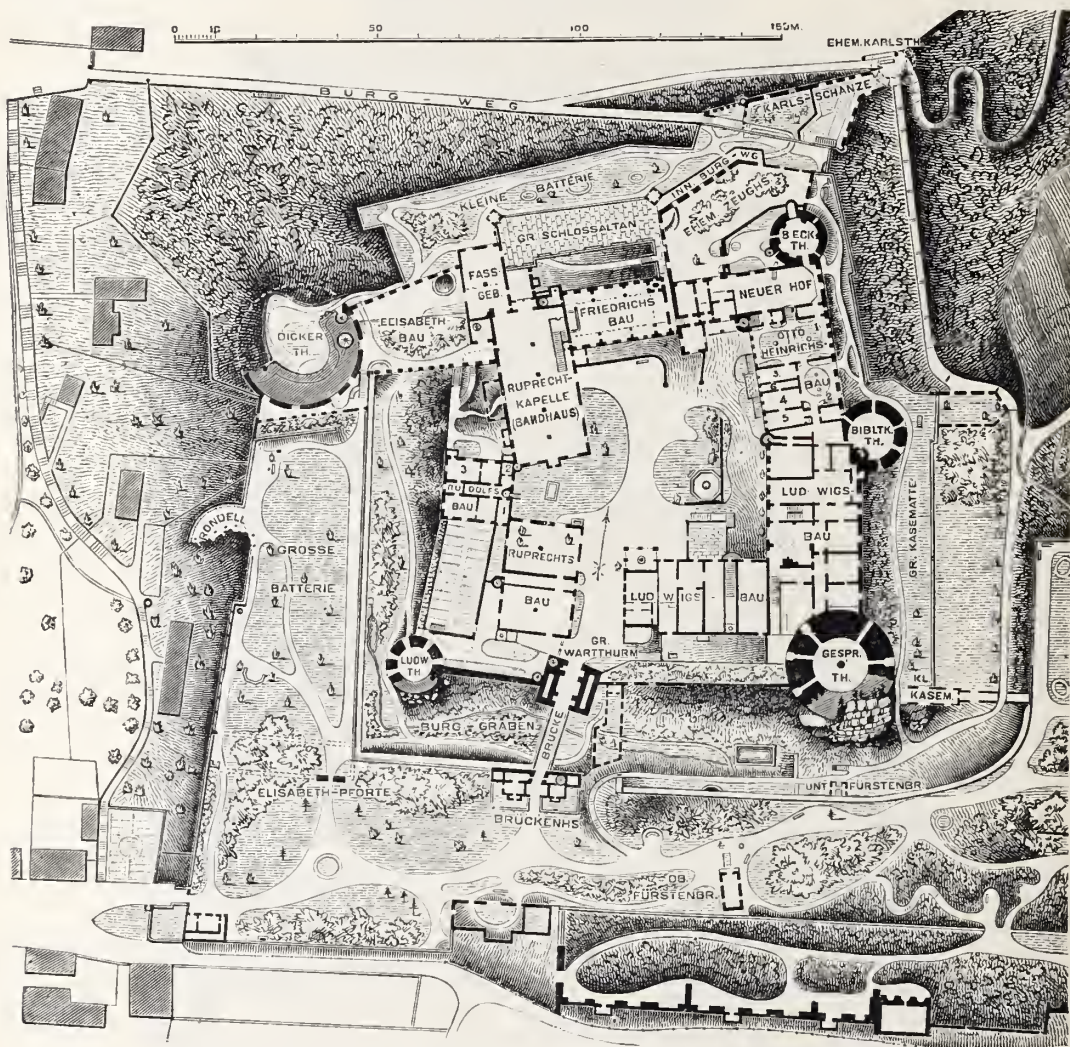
Das Schloß zu Heidelberg. Lageplan.
